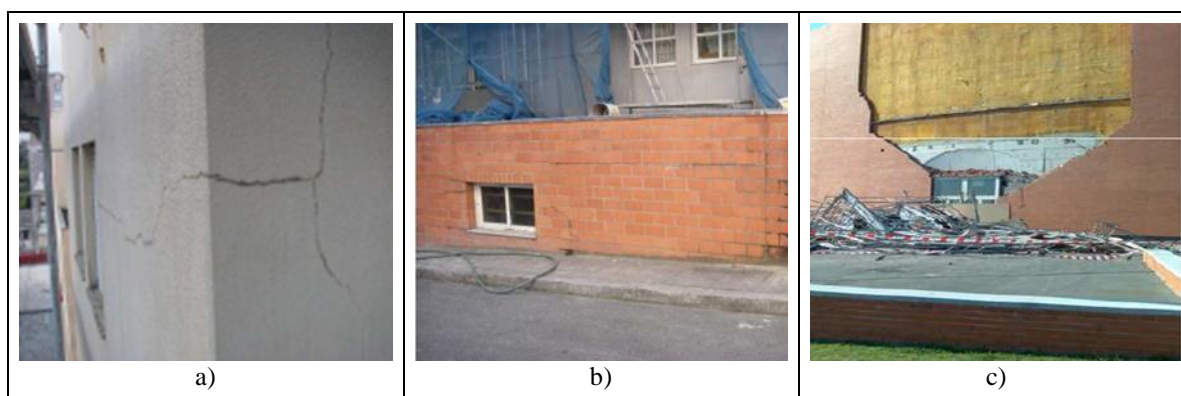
Anomalias em paredes de alvenaria: a) fissuração a meia altura dos pisos (Coutinho, 2011); b) fissuração horizontal acentuada; c) instabilidade global do painel
